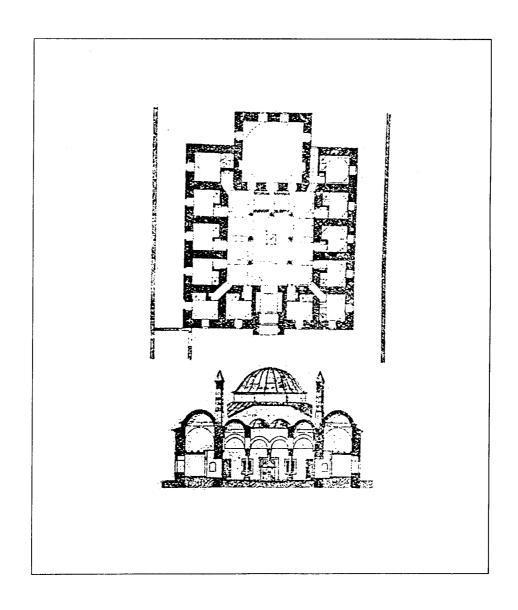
مسقط أفقي لمسجد السلطان أحمد المعروف بالجامع الأزرق في إستانبول (عن : جابرييل) .
